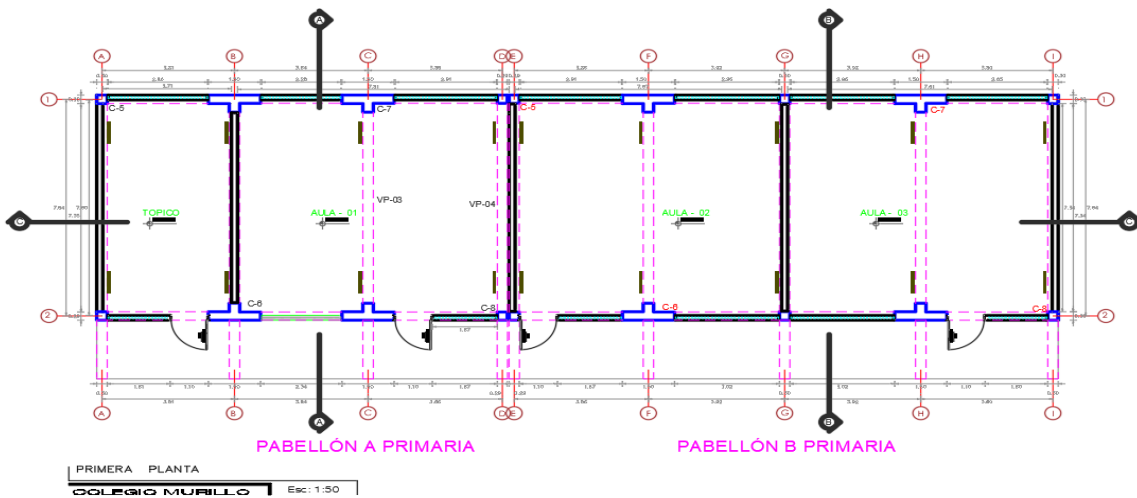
Planta de Primer Piso, Pabellón 101 A y 101 B I.E. N°41026
